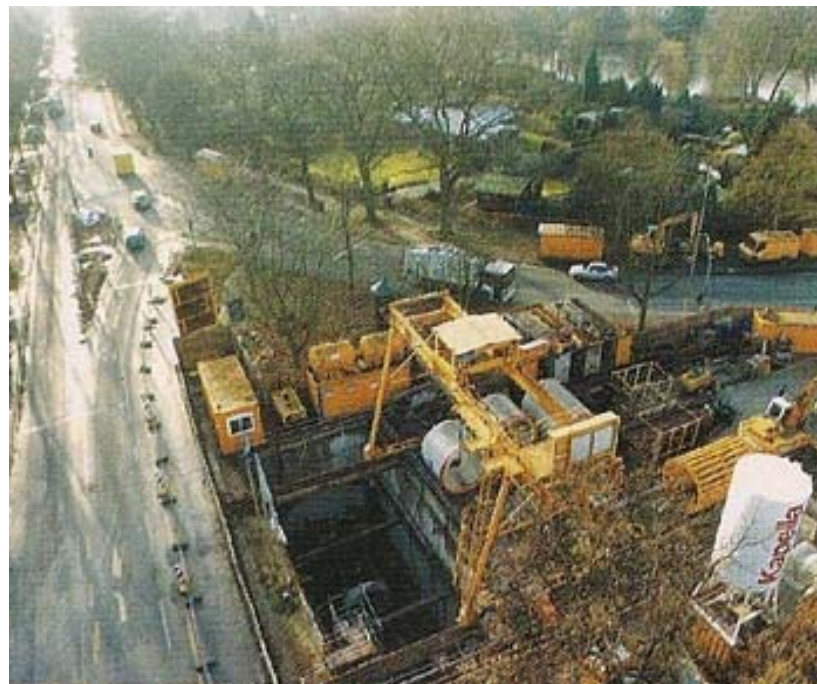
Obra de Pipe Jacking em Região Urbana, com o mínimo de interferência (restrita ao poço de cravação)
